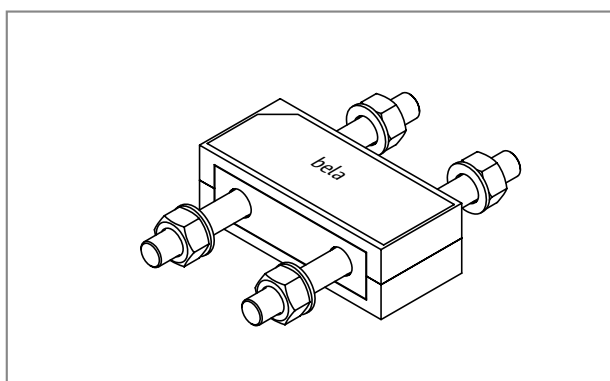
Schöck Isokorb® T tip S-N-D16: prerez izdelka
